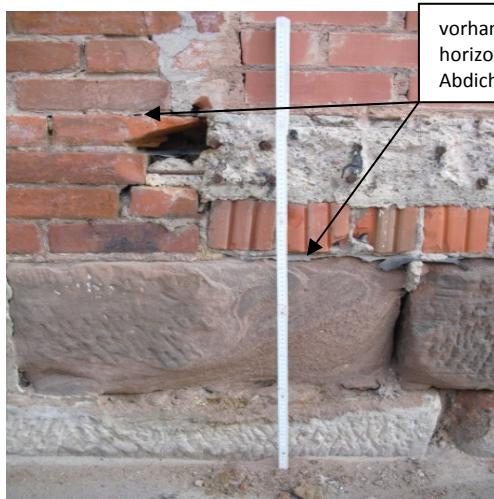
UB2; Überblick linker Anfang der ehemaligen Stahlbeton- Kragplatte
